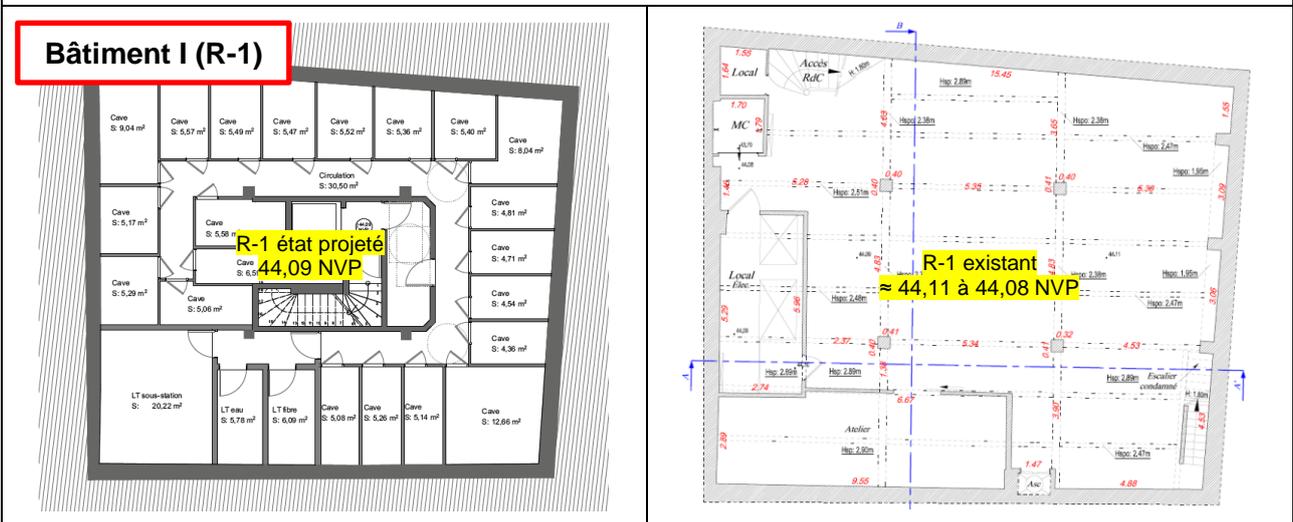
Extrait du plan R-1 du bâtiment I daté du 17/11/2023, et extrait du plan RDC existant, du 12/04/2023
